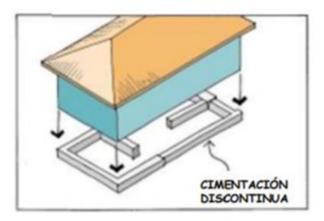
V. Media. Cimentación. Chavarría y Gómez (2001)
